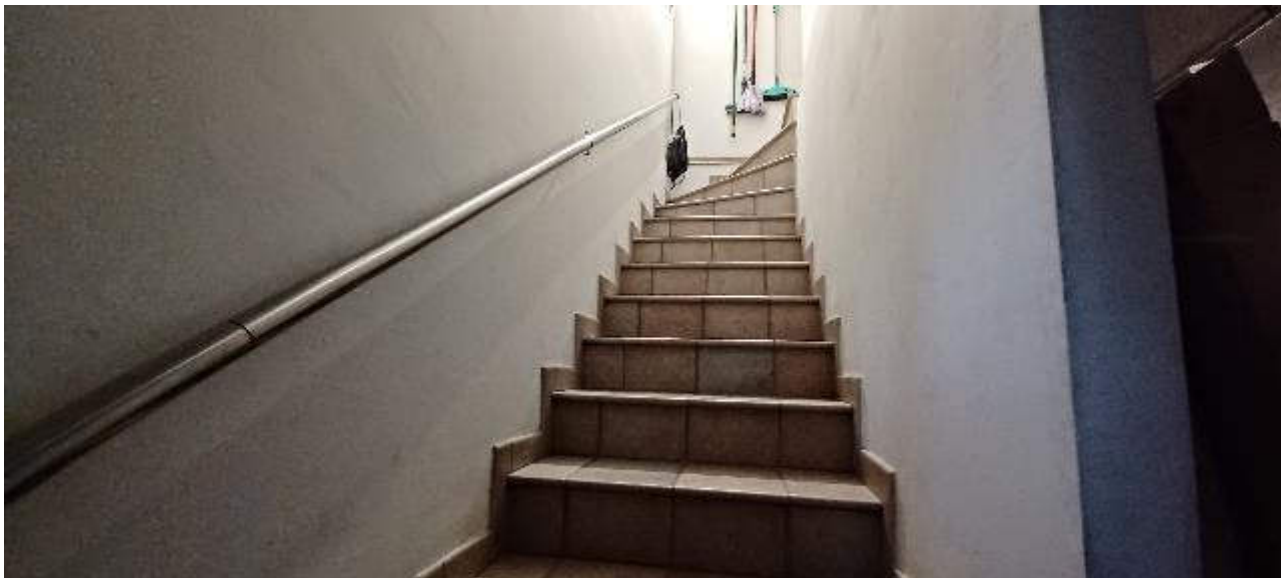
Scale in terne dal piano seminterrato al piano terra
